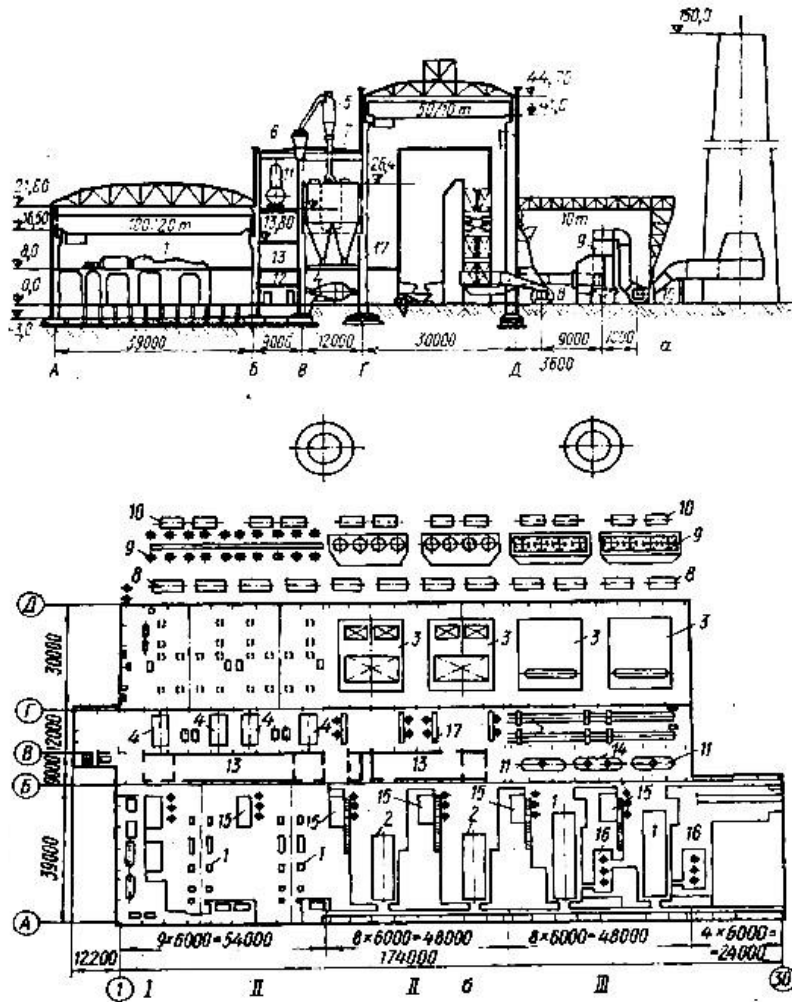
Поперечний розріз (а) і план (б) головної будівлі
